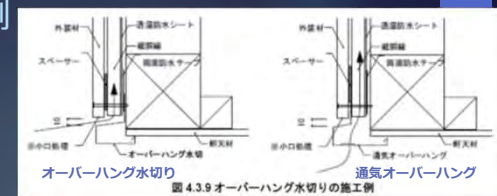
オーバーハング水切りの構造 図 4.3.10 外壁通気の出口側経路の施工例 (軒の出がある場合)
